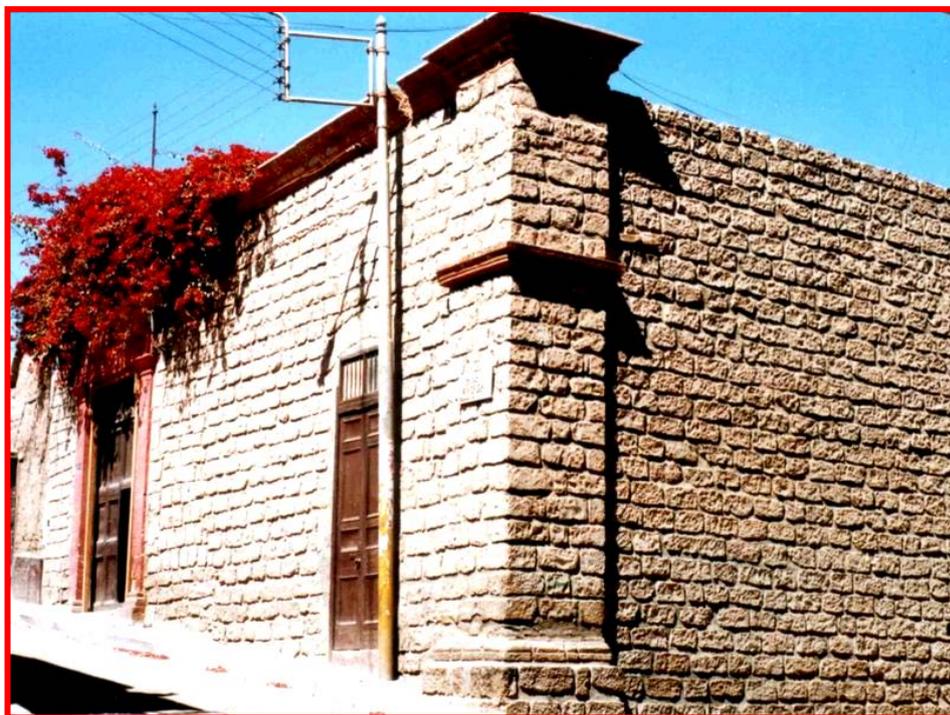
Fachada en piedra calicanto, de la casa Podestá, plaza de armas de Moquegua.
